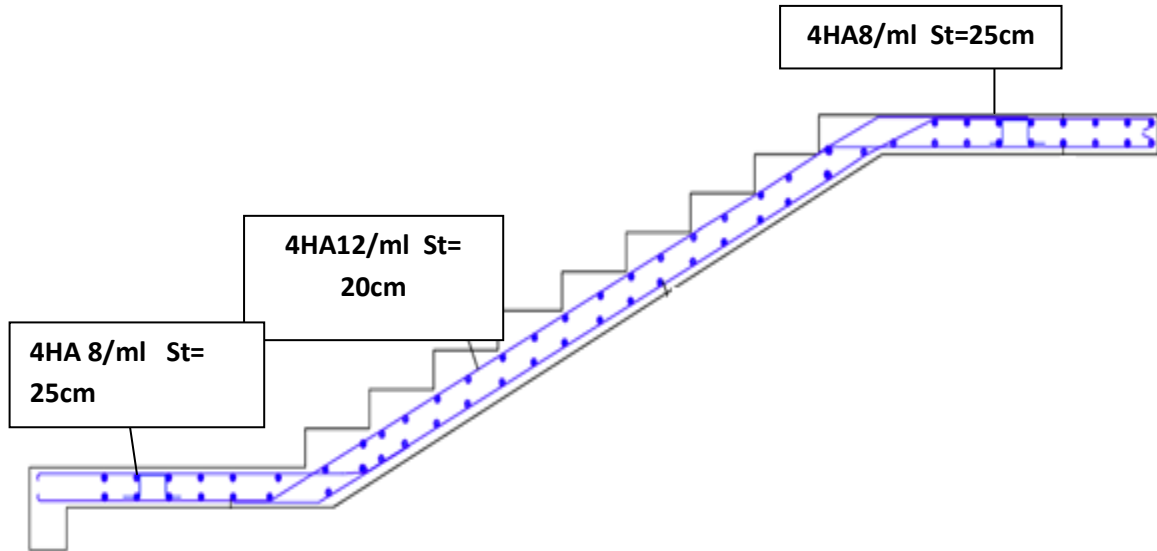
Plan de ferrailage de l'escalier étudié.
